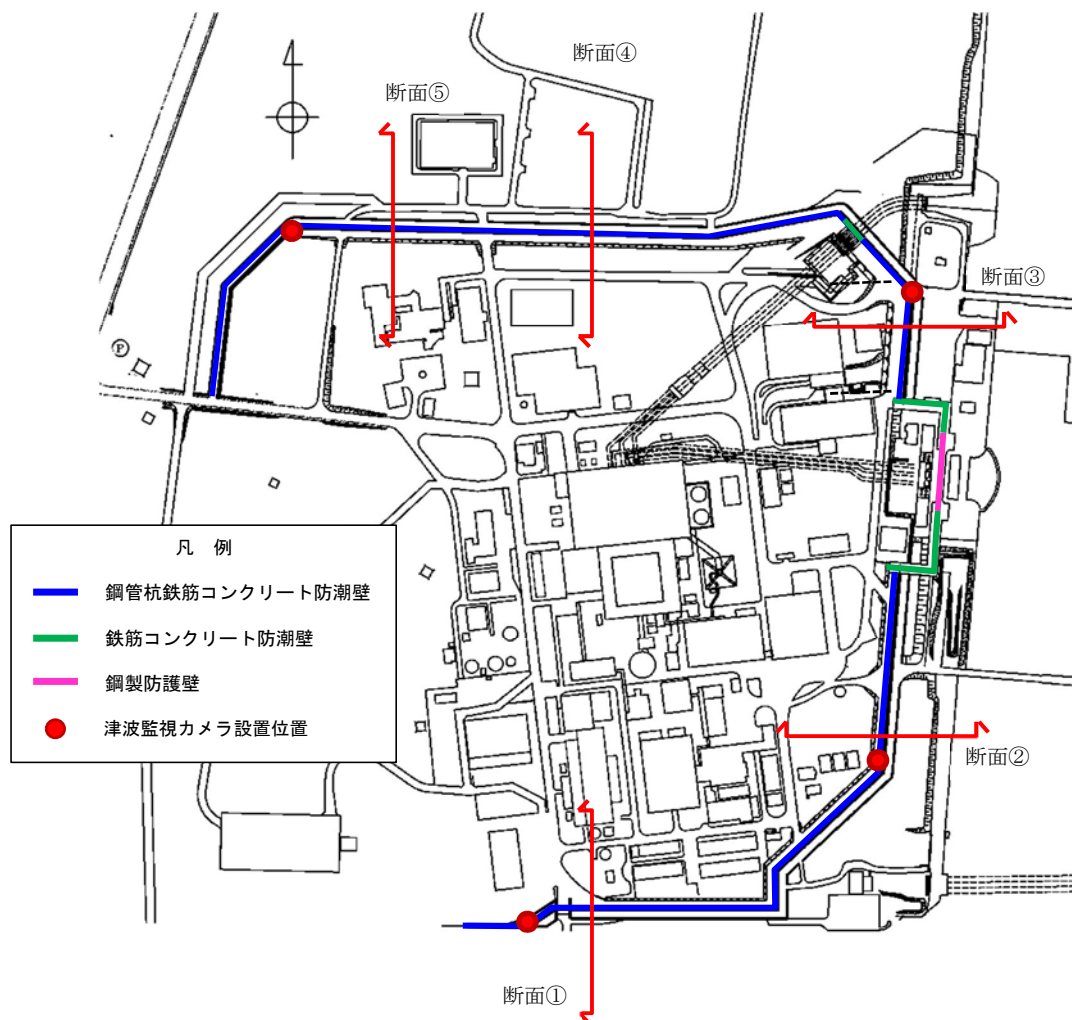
鋼管杭鉄筋コンクリート防潮壁及び津波監視カメラの位置図
